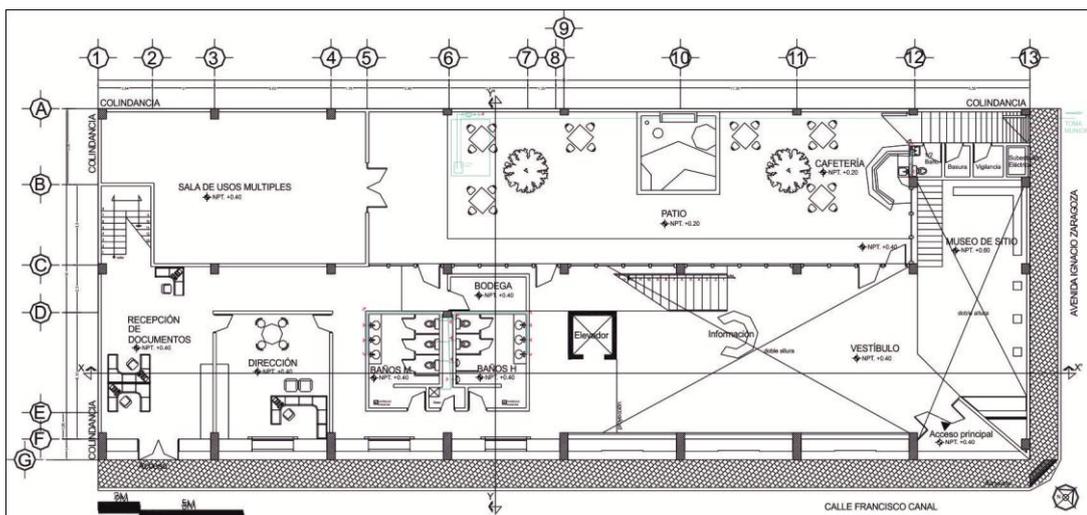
Proyecto ejecutivo: instalación hidráulica. Planta baja.
